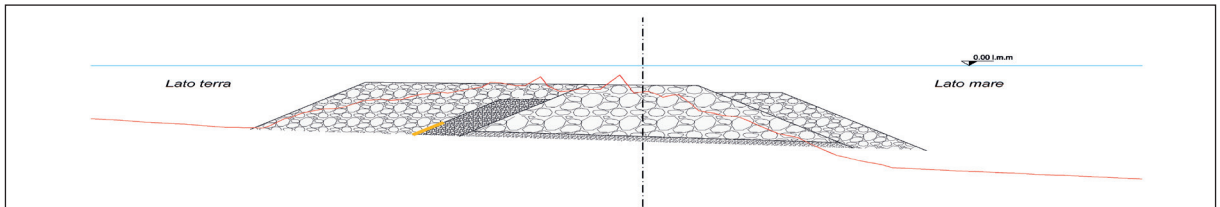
Sezione "tipo 2" della scogliera - Sovrapposizione della sezione di progetto con la sezione di rilievo n. 40.
